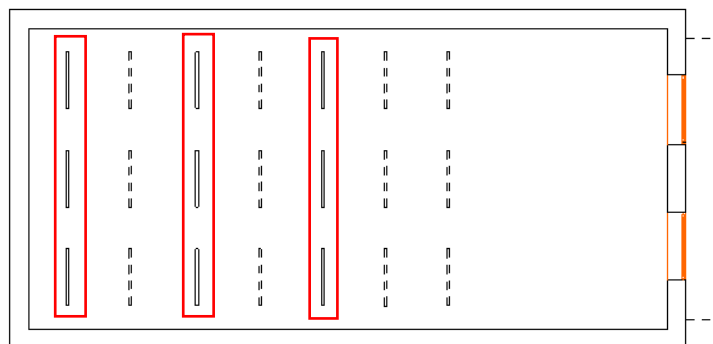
Plan d'un local équipé d'un PAI avec trois sorties de light duct (Source : Auteur)
